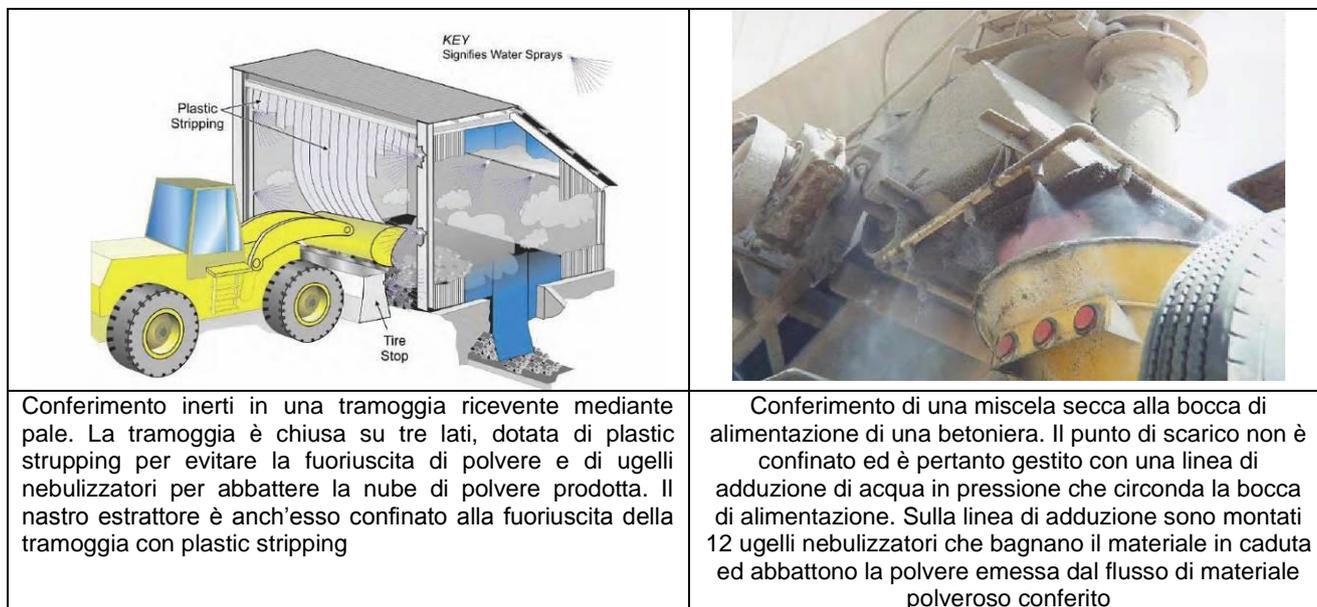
ESEMPI DI INTERVENTI DI SECONDARI PER IMPIANTI DI BETONAGGIO
